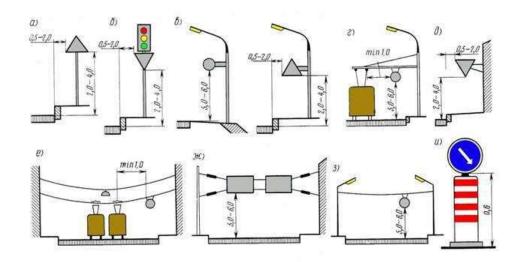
Способы установки знаков в населённых пунктах: а, б - на специальных стойках; в, г - на мачтах освещения; д - на стене здания; е - на тросах-растяжках; и - на круглой тумбе
